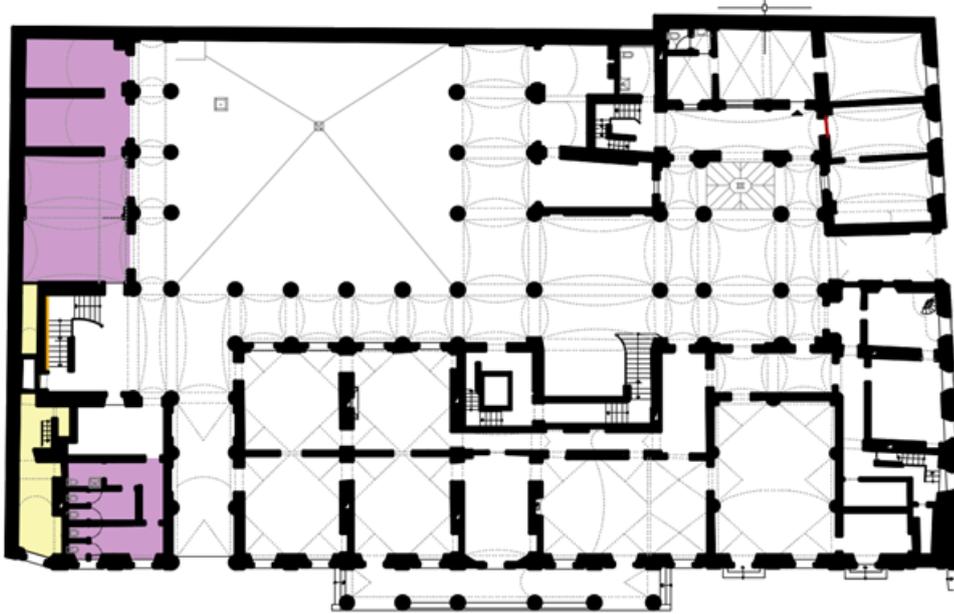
Pianta piano terra. Sistema distributivo dell'UTA 3
